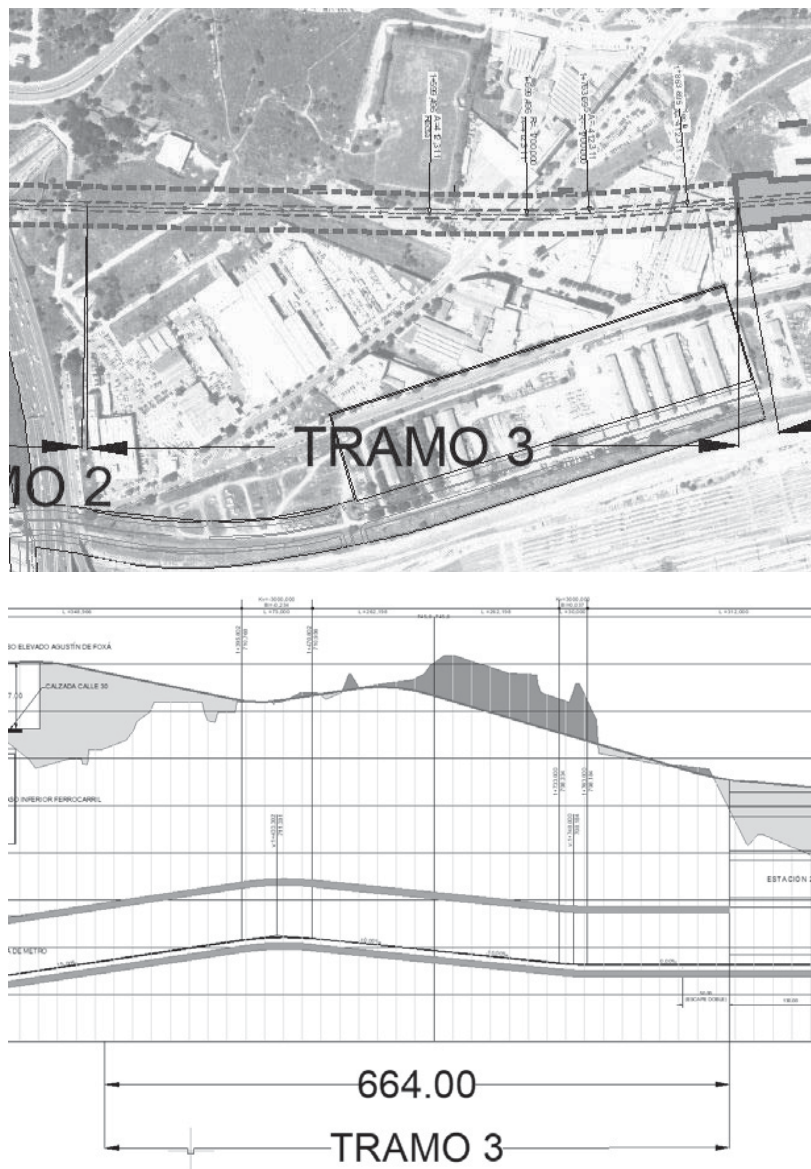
Planta y perfil tramo 3 nueva línea de Metro
